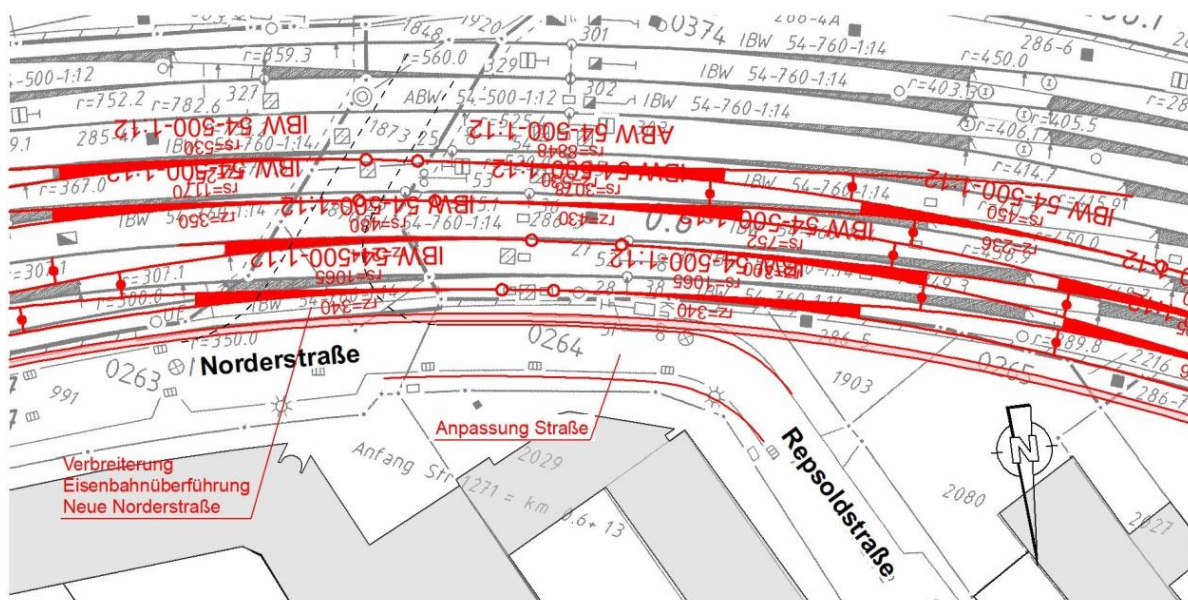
Lageplan Variante 2 Bereich Repsoldstraße/Norderstraße
